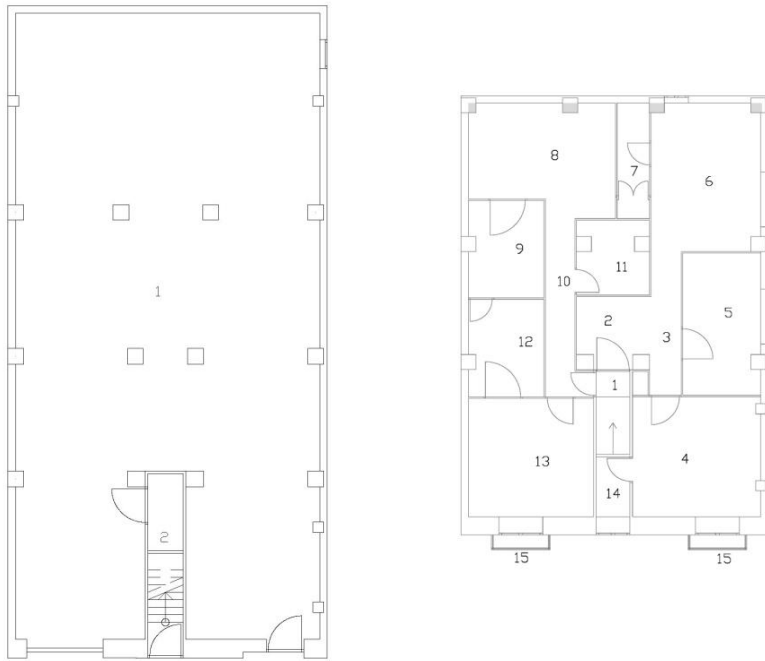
y 33. Planos superficies planta baja y planta primera. 2016. Propia.
